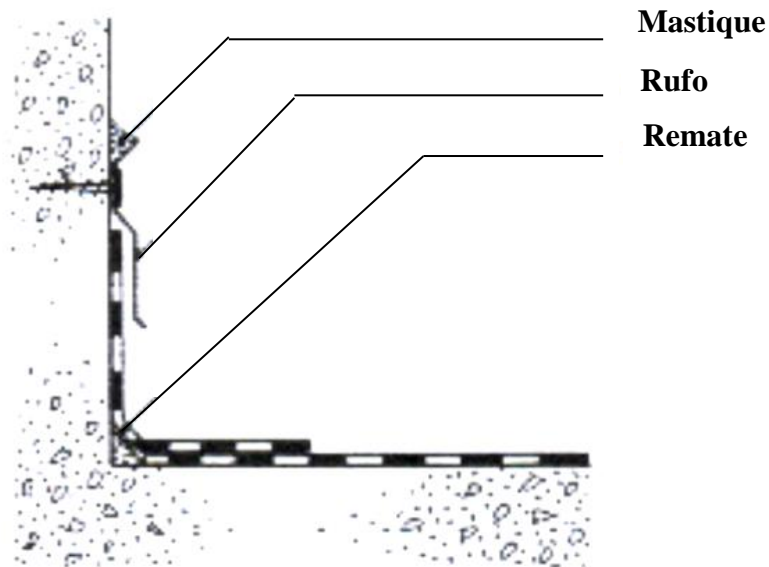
Remate, com recurso a rufo metálico, do sistema de impermeabilização no pilar
